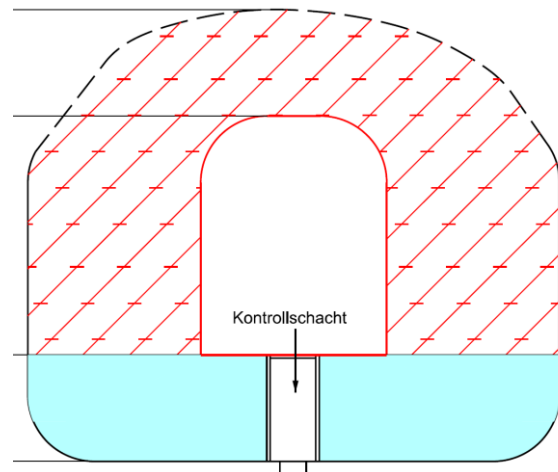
Prinzipskizze der Offenhaltung eines kleinen Streckenquerschnitts mit Betonausbau
